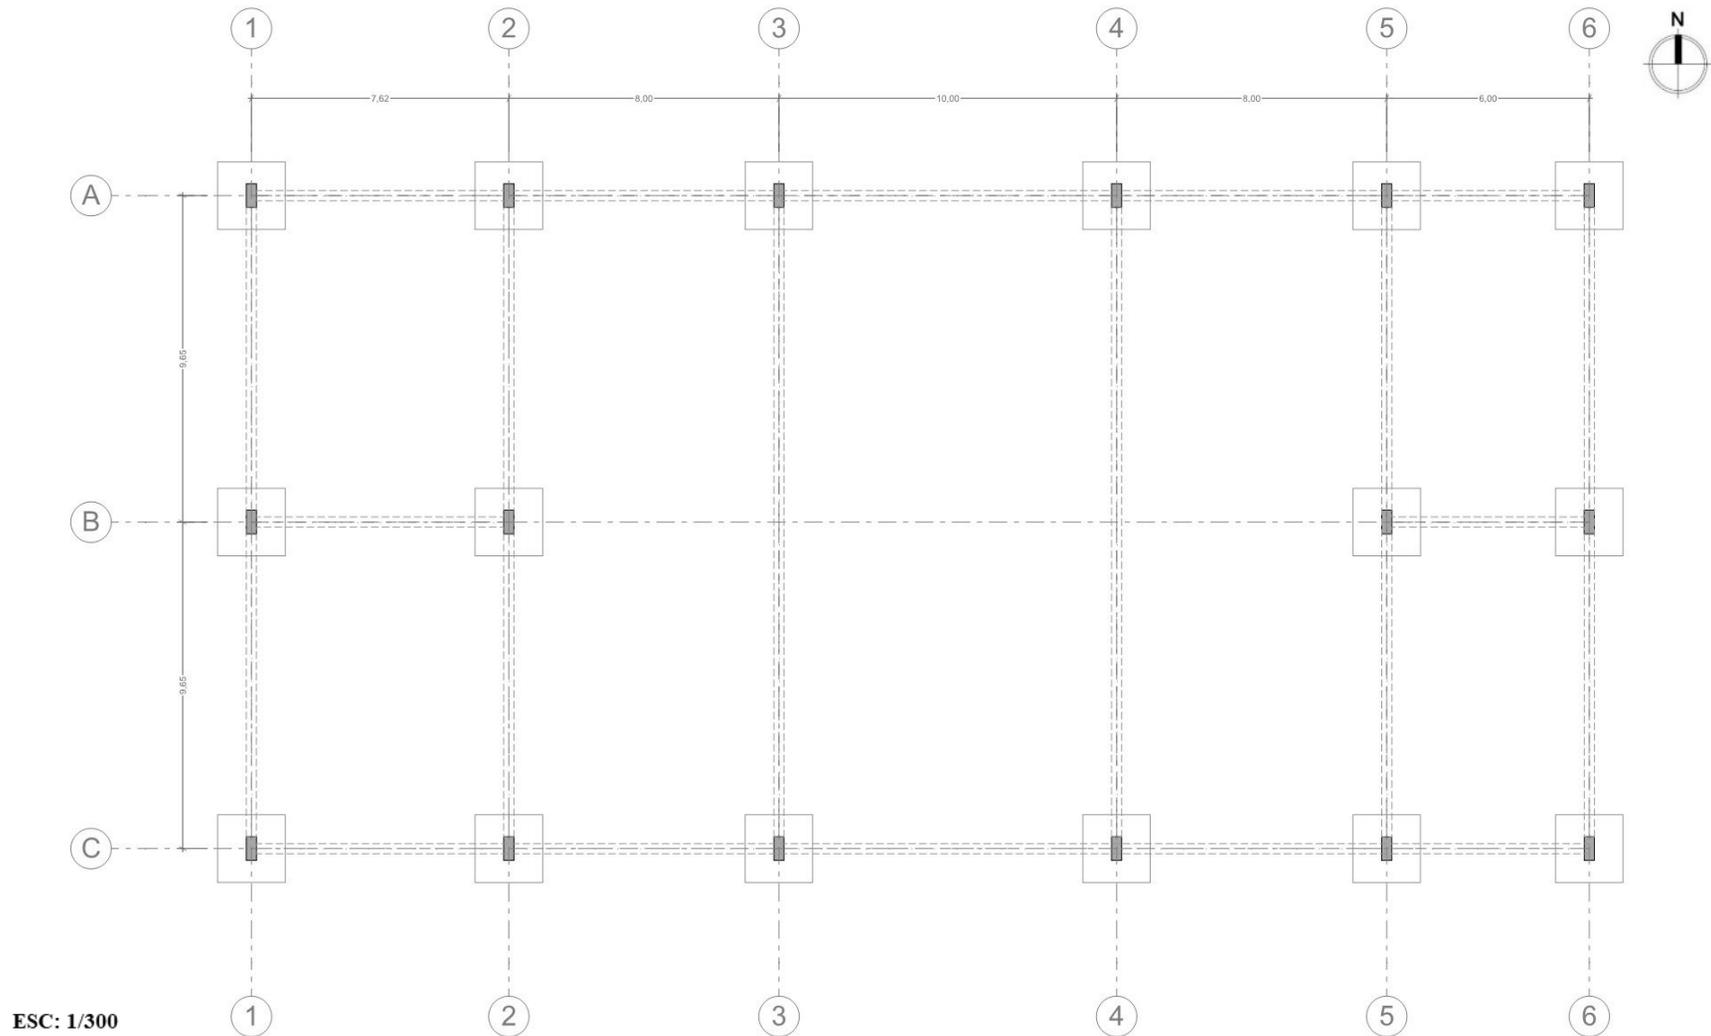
Bloque B Cimentación / Fuente: Elaboración propia
